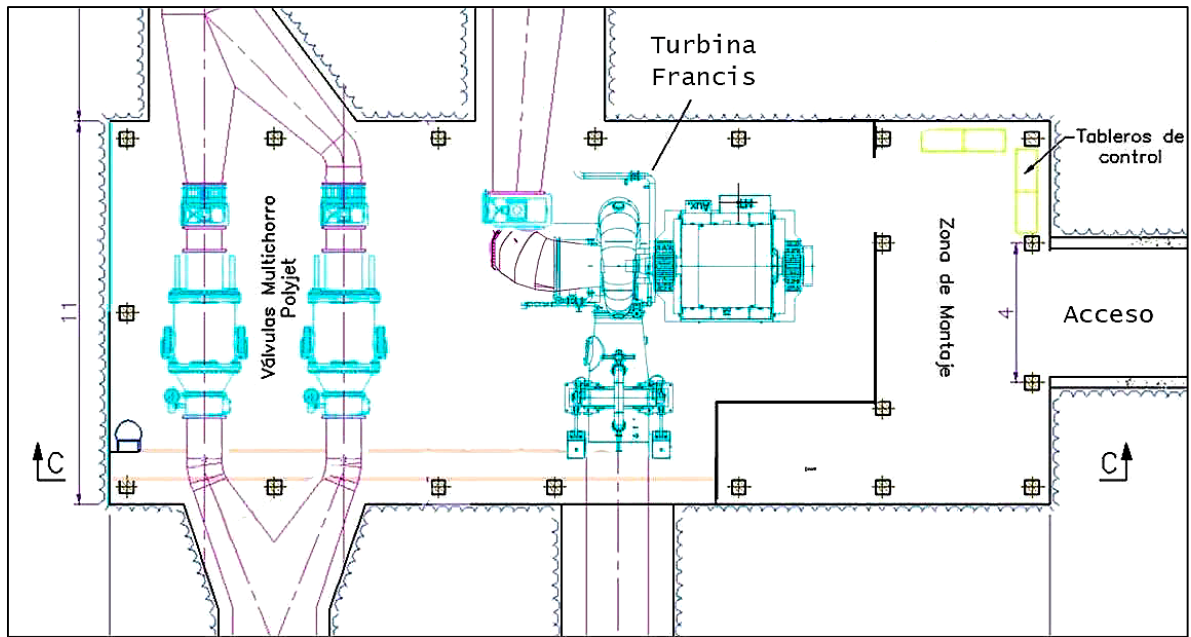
Planta de distribución esquemática de la casa de máquinas.
